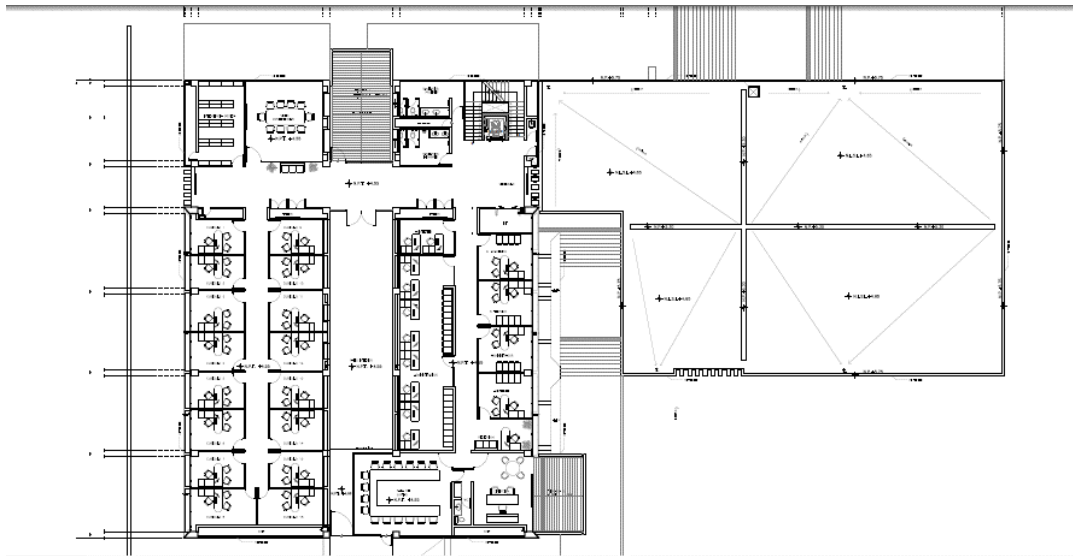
primer nivel del CNYN. Recuperada de planos originales.
